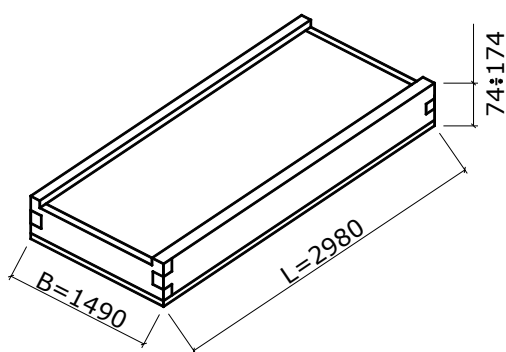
Плита покрытия типа «сэндвич» с обшивкой из асбесто-цементных, деревоволокнистых плит и утеплителя из фенольного пенопласта
